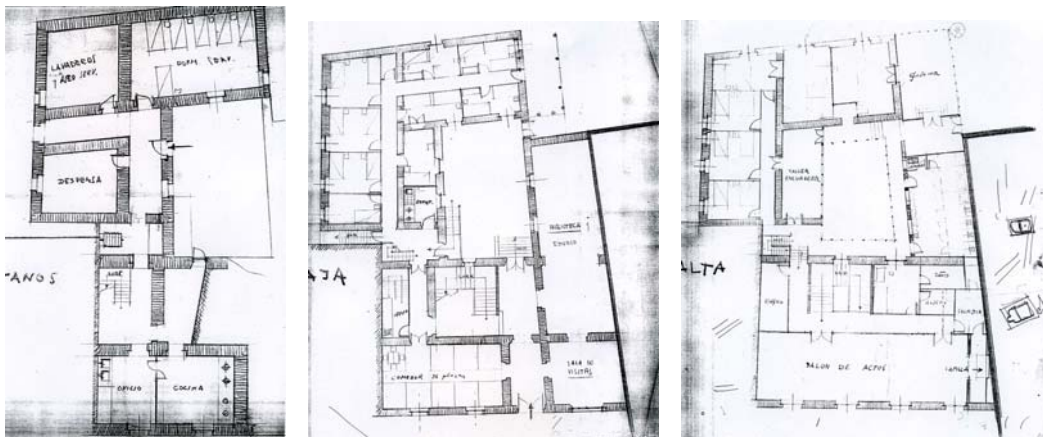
C. M. Santa María de los Ángeles: semisótano, planta baja y primer piso; por Fernando Población del Castillo, julio de 1951.
